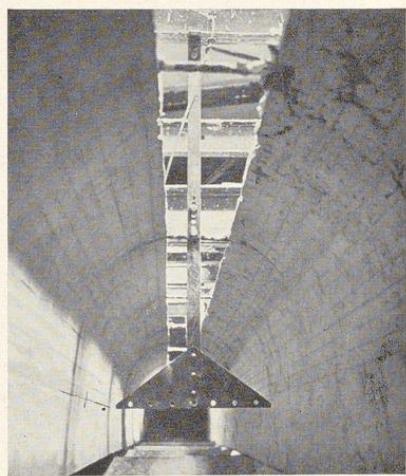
Der zusammenschiebbare Abhänger für das Beleuchtungsbrett
